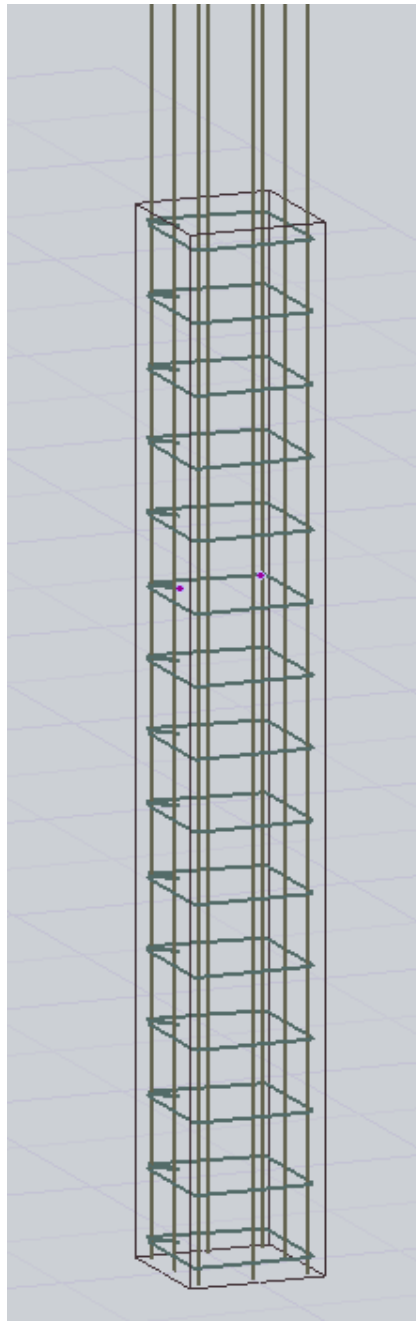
Схема армування та переріз типової колони К-1
